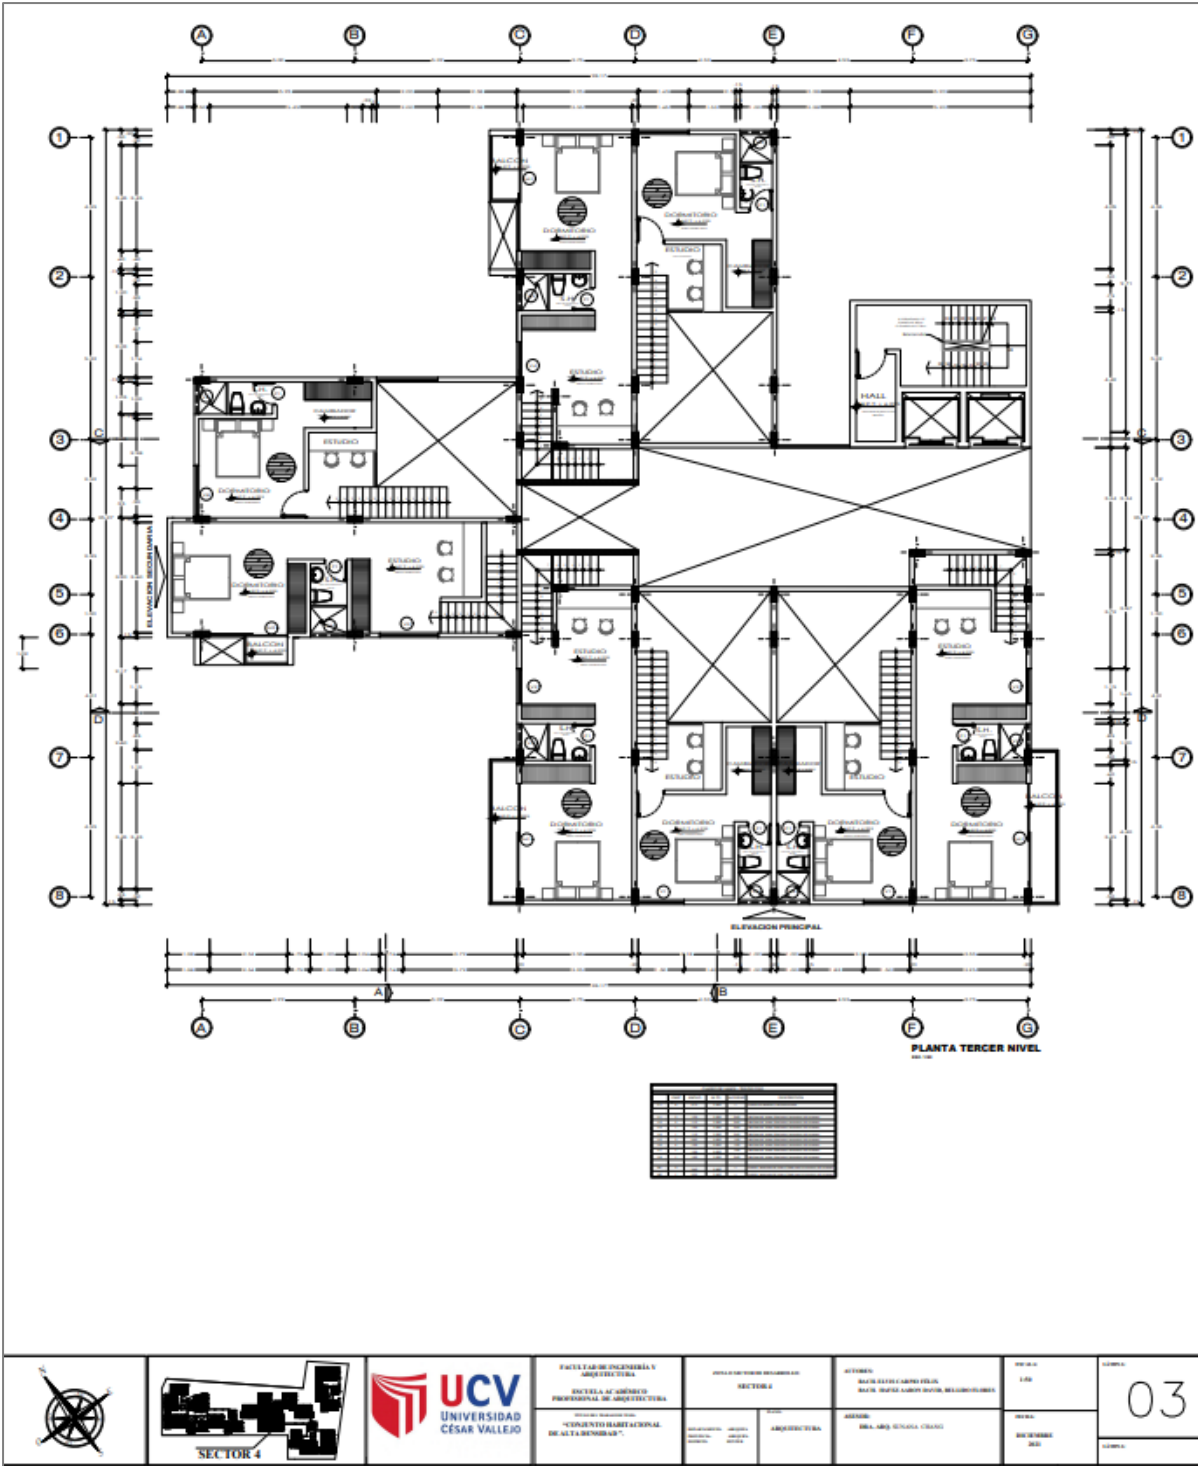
Planos de Arquitectura – 03 - Bloque 4 – Tercer Nivel
